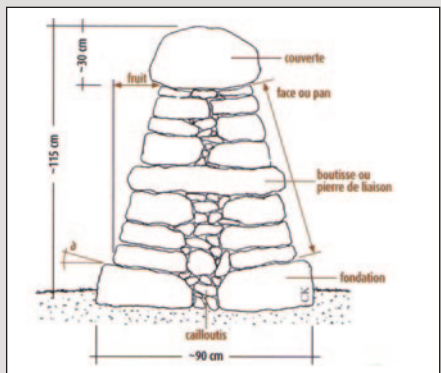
Schéma de construction d'un mur de clôture en pierres sèches.
